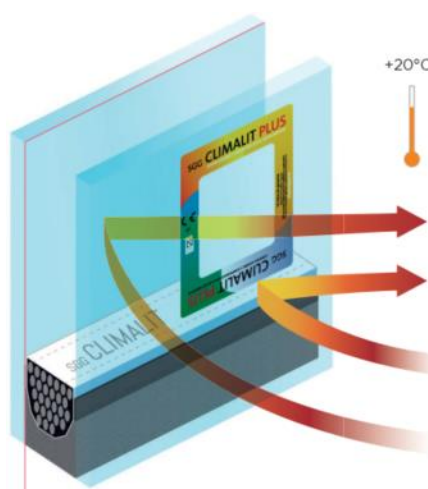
Detalle do vidro SGG Planitherm XN. Fonte: Saint Gobain.
